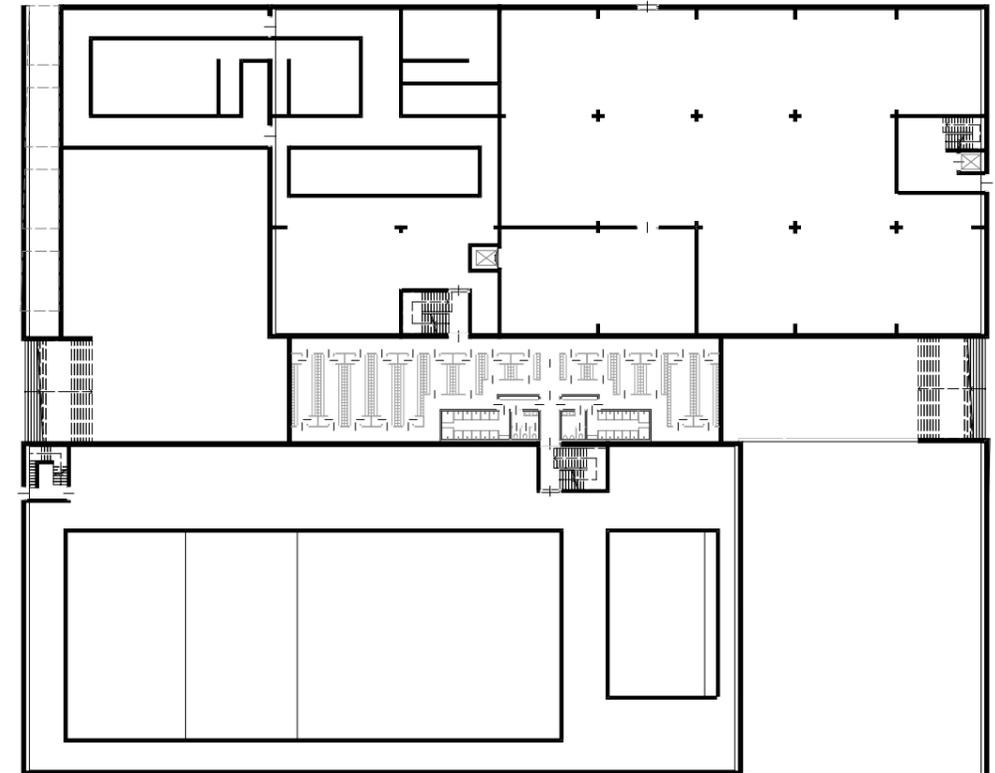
Grundriss Erdgeschoss 1:750
